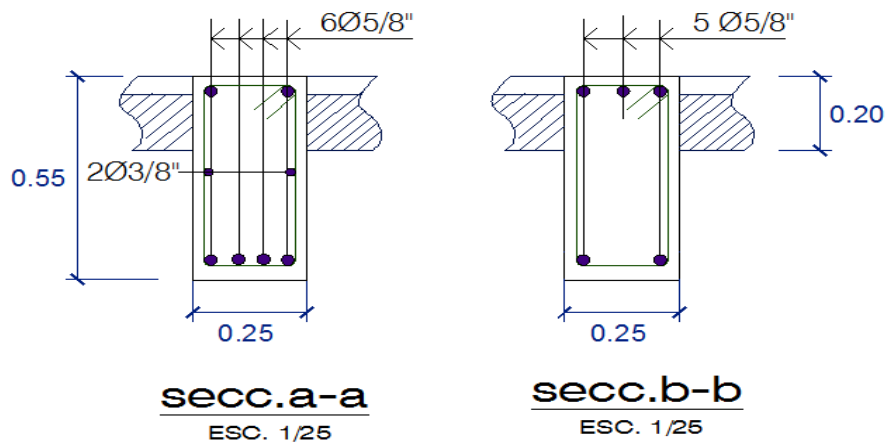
Viga propuesta VR-1 sección 25x55 cm
